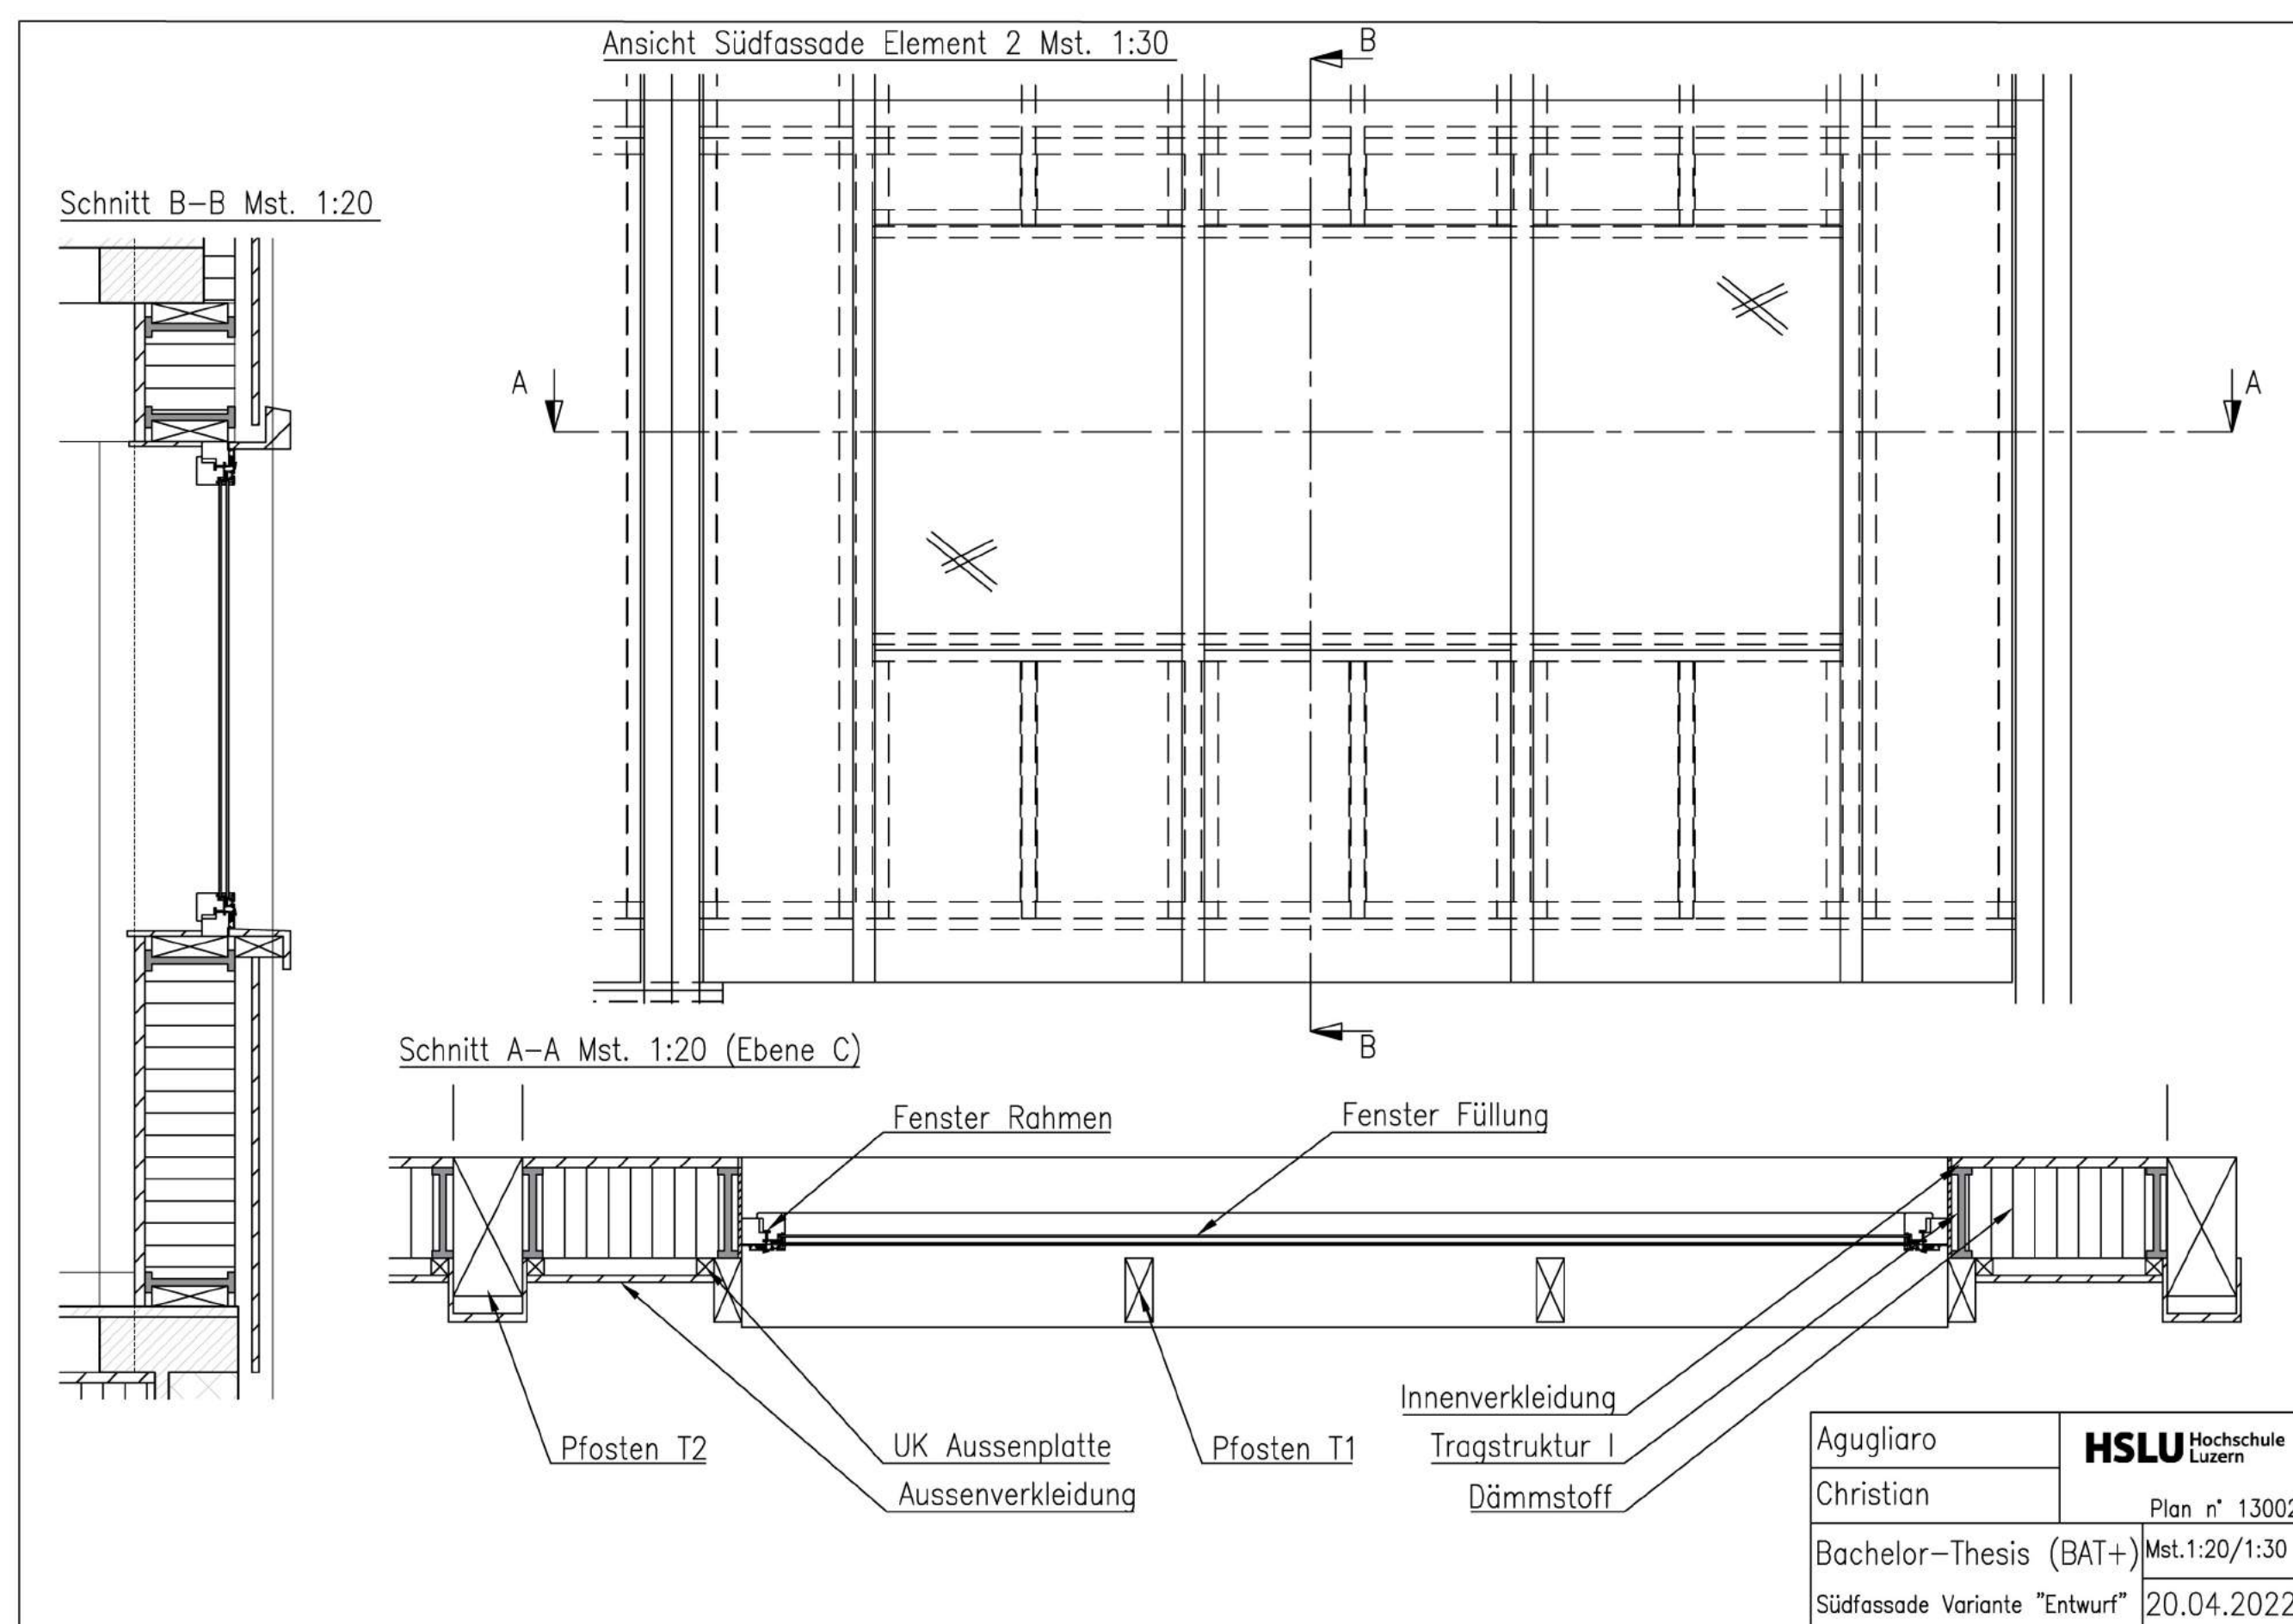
Prinzip Plan eines „Entwurf“ Element
